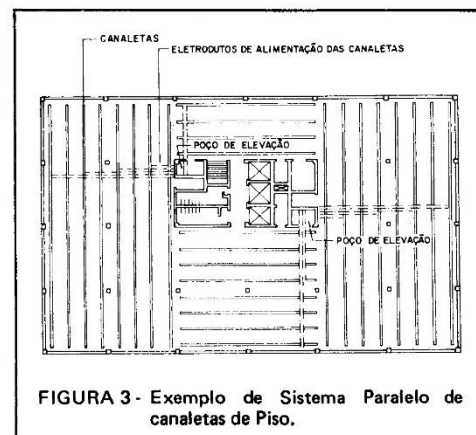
Exemplo de Sistema Paralelo de canaletas de Piso.
